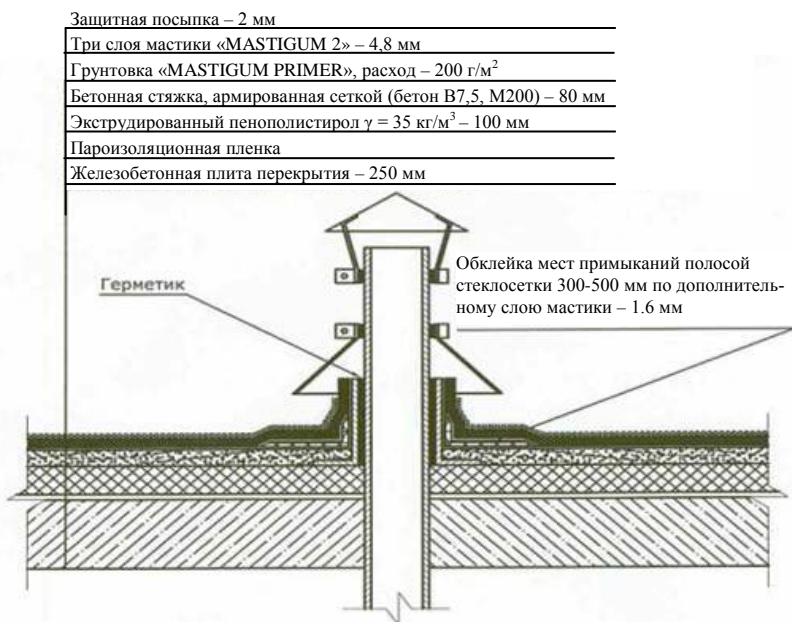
Примыкание кровельного ковра к вентиляционным трубам
